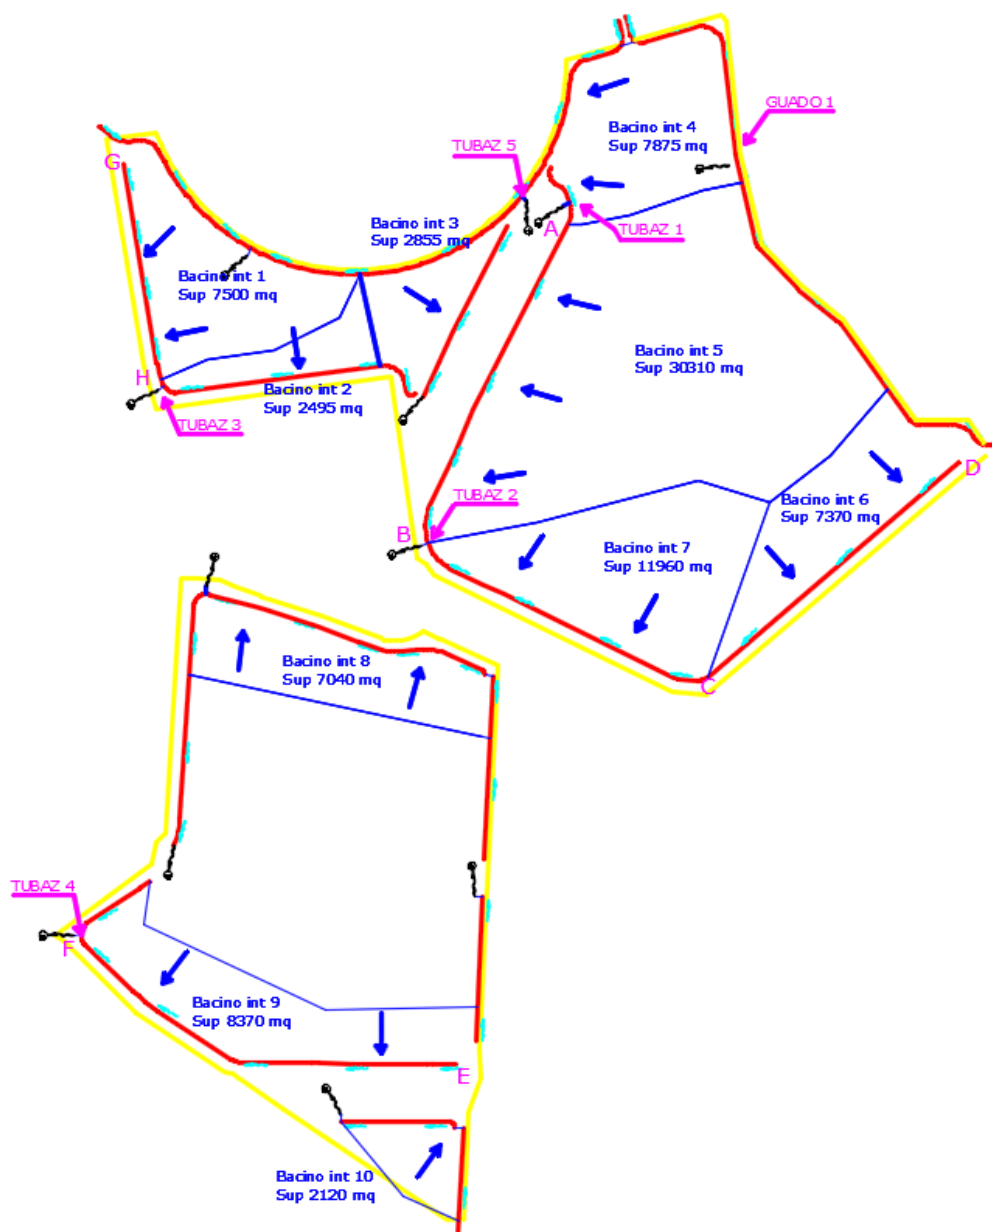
Planimetrie con individuazione dei bacini interni all'impianto
